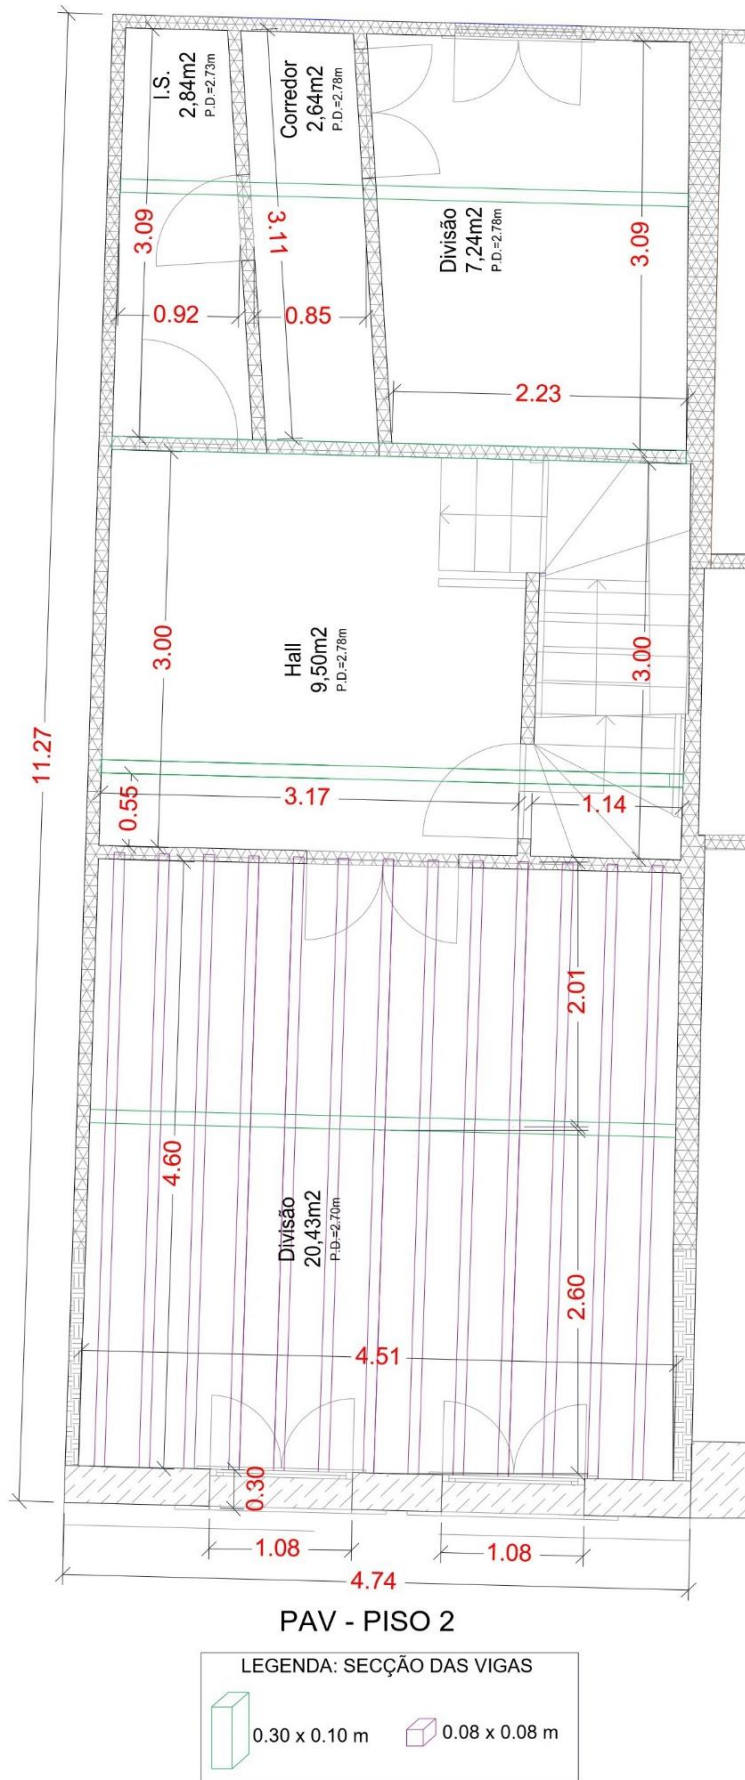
Disposição das vigas no pavimento do Piso 2
